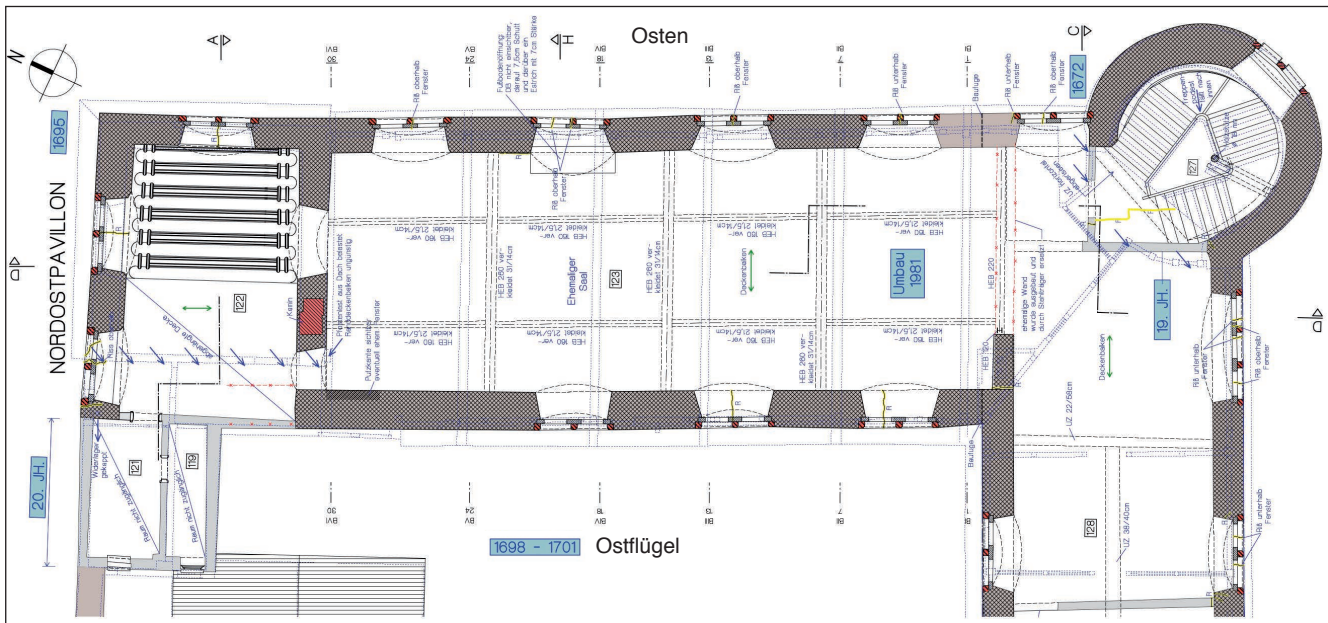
Grundriss des Ostflügel-Obergeschosses.
